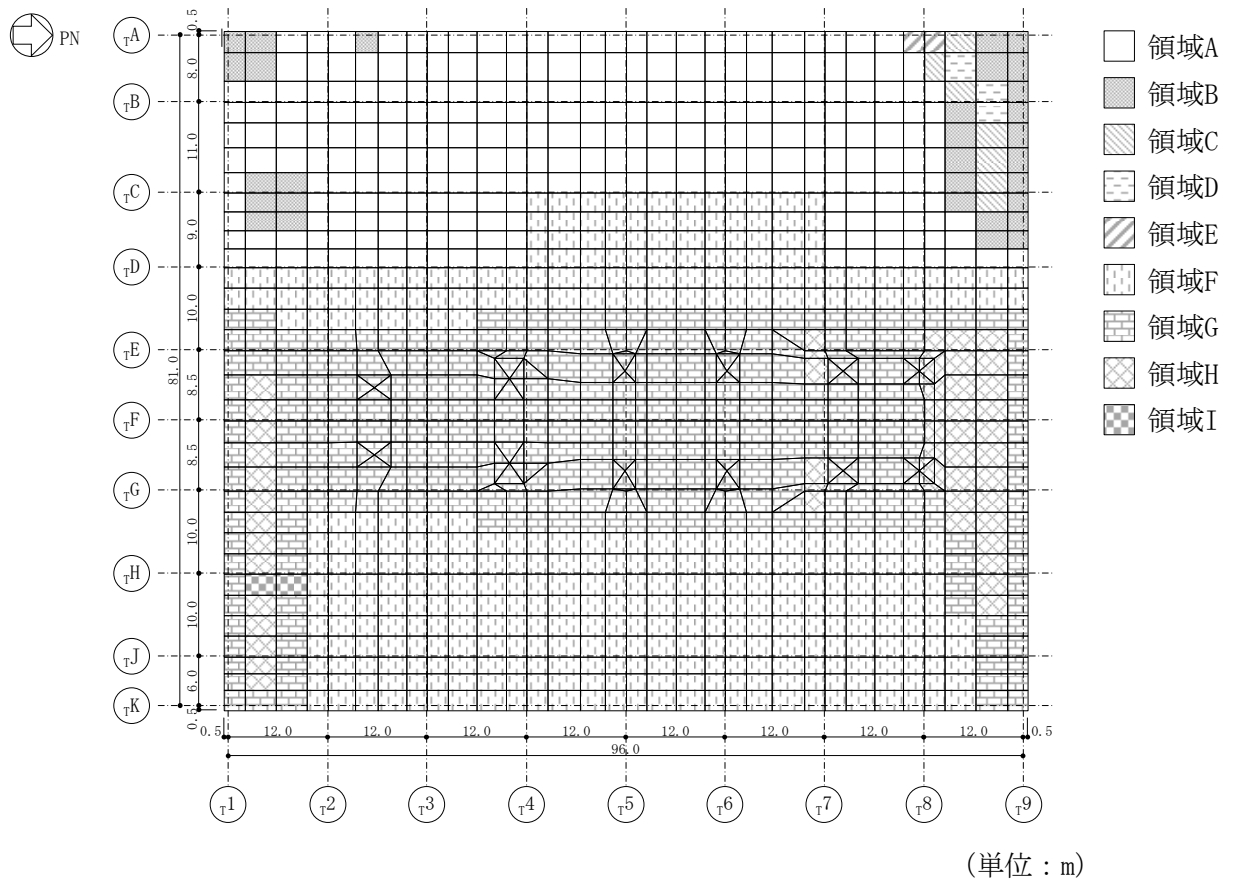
基礎スラブの配筋領域図 (NS 方向, 上ば筋)
